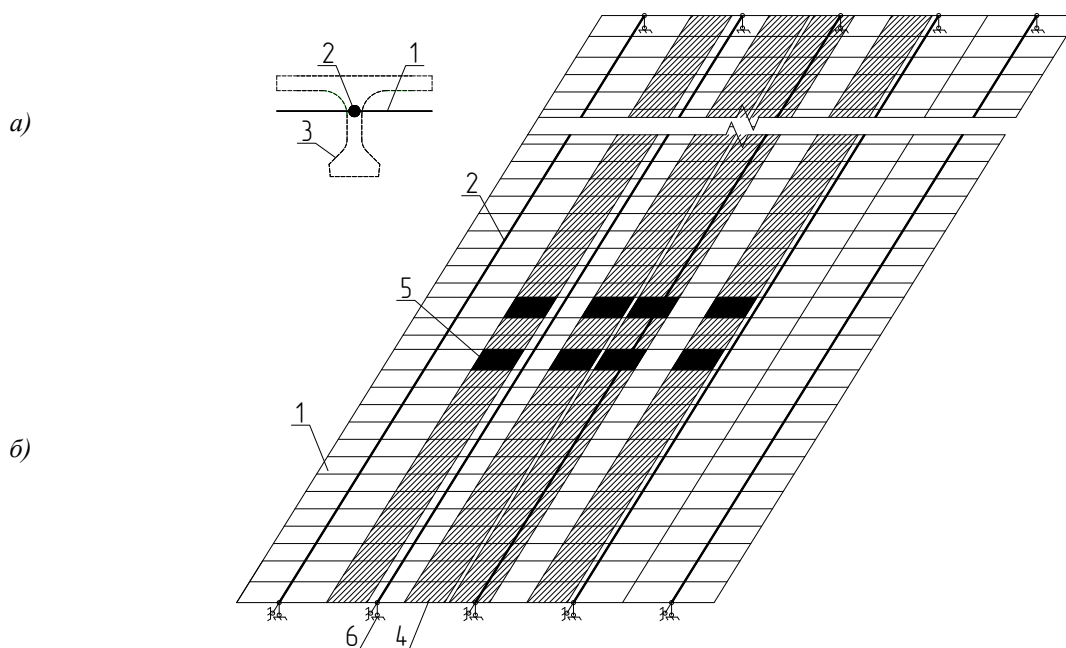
Плитно-стержневая расчётная схема МКЭ: *а* – расчётная схема балки; *б* – расчётная схема пролётного строения с двумя полосами временной автомобильной нагрузки АК; 1 – конечные элементы плиты, 2 – стержневой конечный элемент, моделирующий балку, 3 – контур балки пролётного строения, 4 – колеса нагрузки АК, 5 – площадки давления колёс тележки АК, 6 – узлы опирания балок на опору
